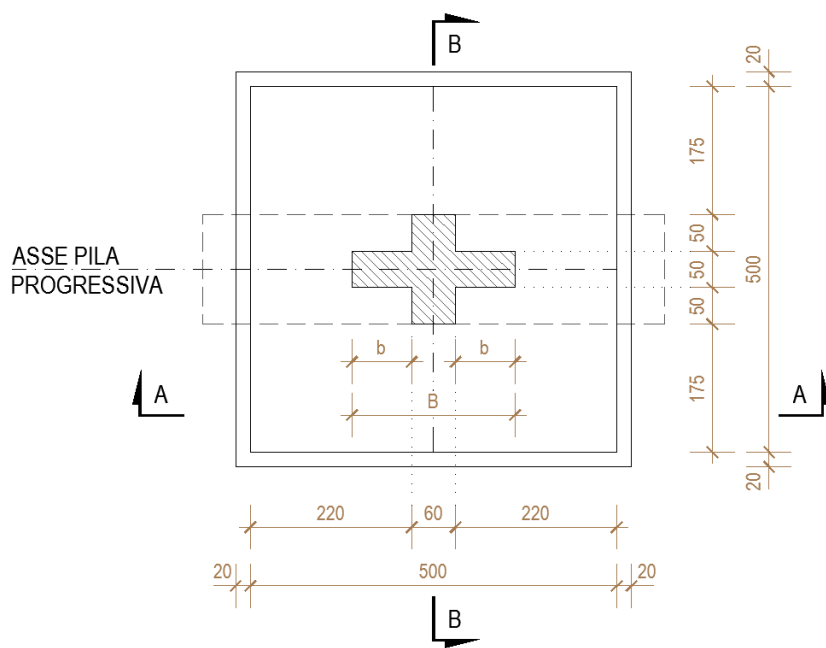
Sezione fusto pile P1 – P2 – P3 – P4 – P5
